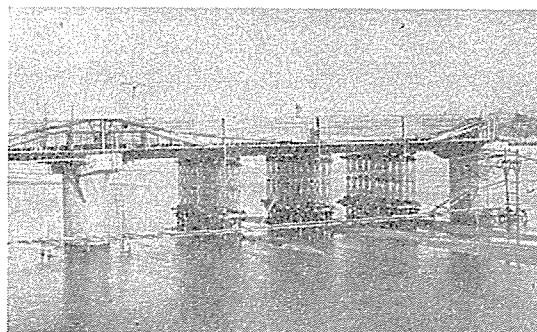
支保工上で施工した新東海道本線矢作川橋梁
